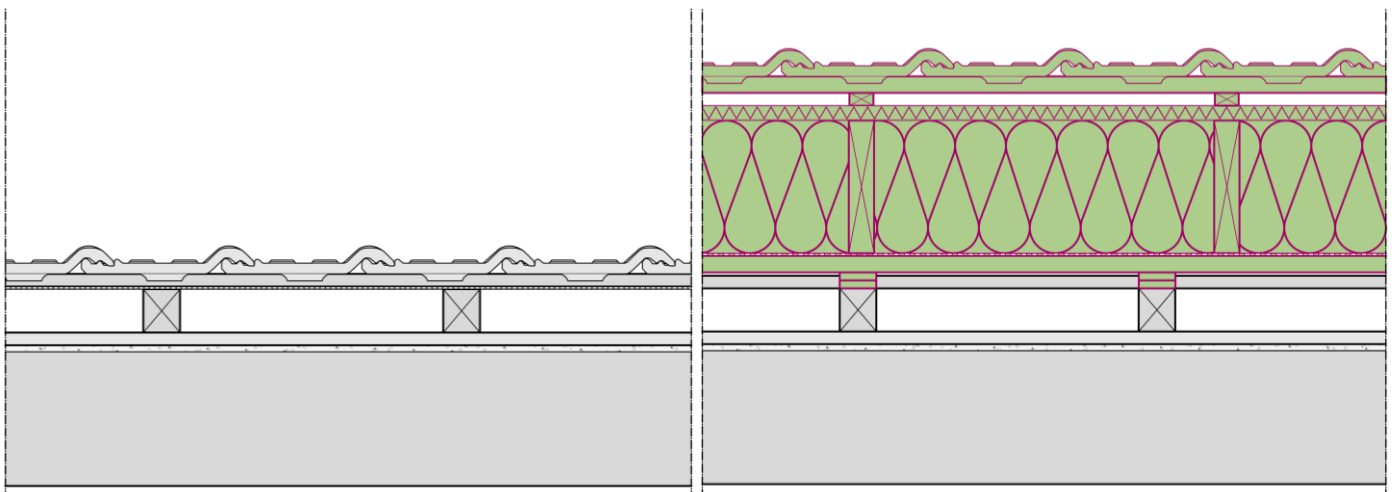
Sarking renovatiewerf met zelfdragende keperplanken en iQ3 cellulose-isolatie. Werf uitgevoerd door DaServ!cio te Haacht.
